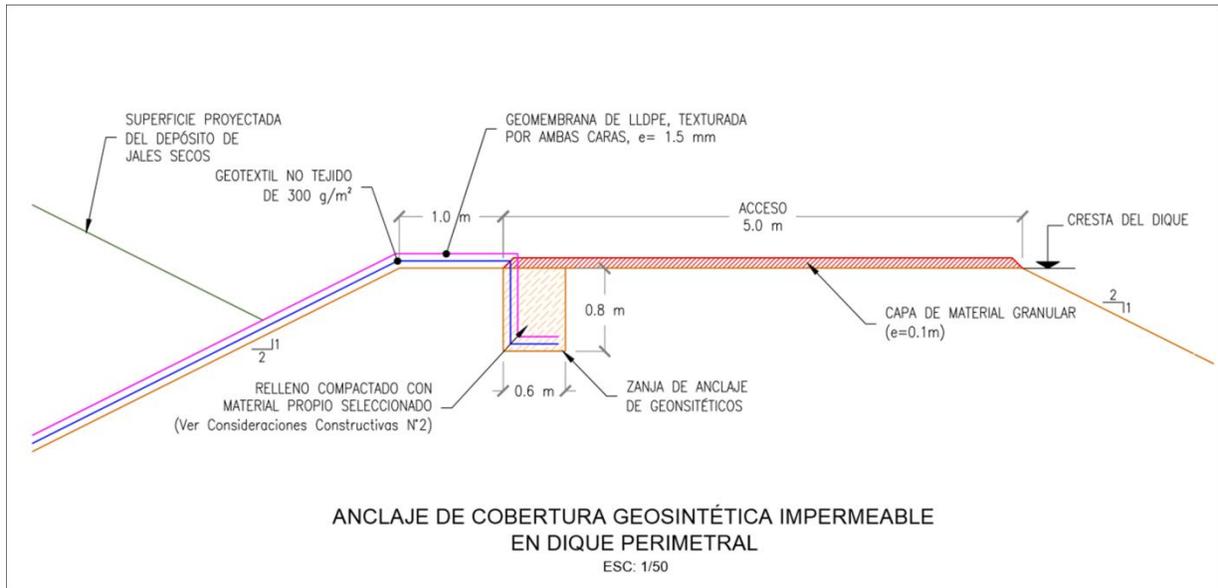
15. Impermeabilizado y anclaje a dique perimetral
